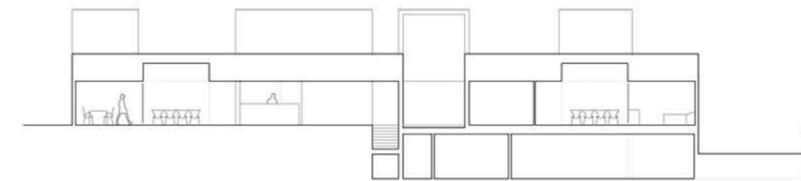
Corte longitudinal del Centro Fuente: Arquinetwork (2007)
